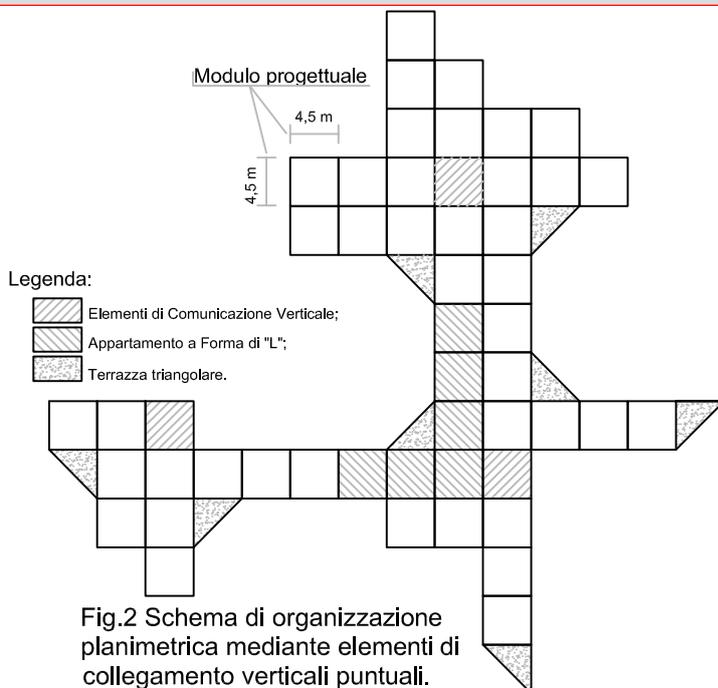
Schema di organizzazione planimetrica mediante elementi di collegamento verticali puntuali.
